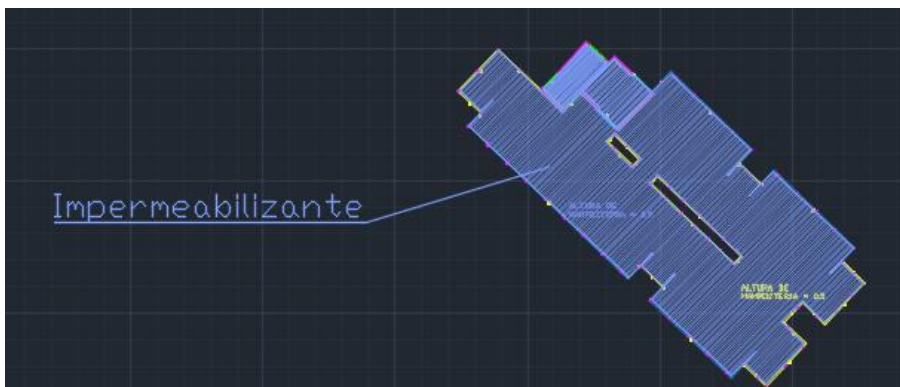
, Cubiertas de torres que deben ir impermeabilizadas
